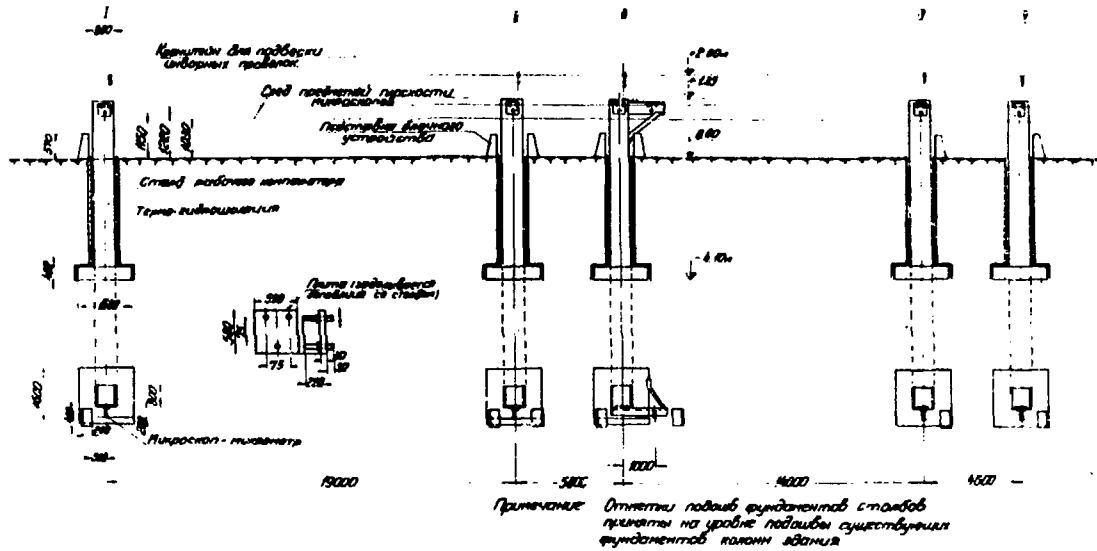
Схематический чертеж рабочего компаратора УТЗФ
